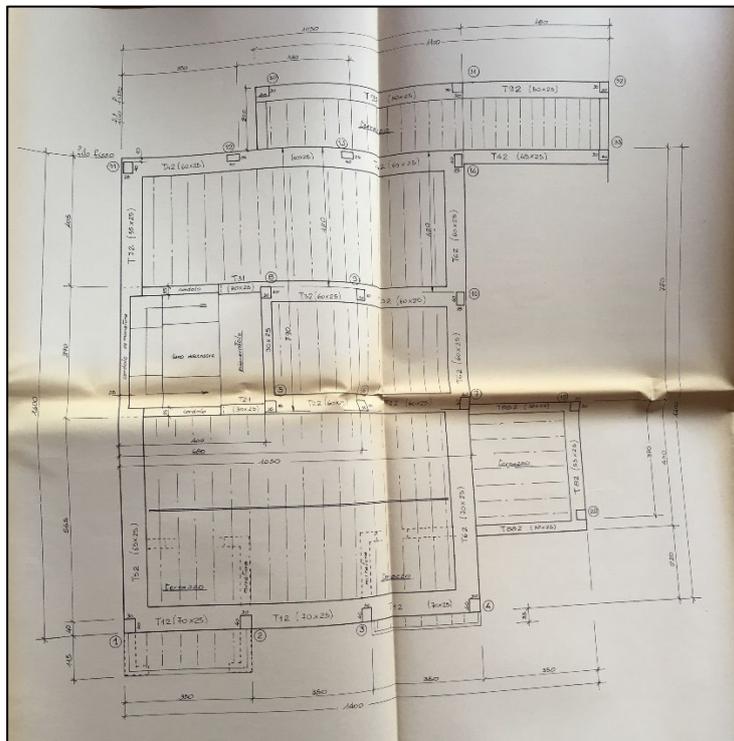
Pianta del terzo orizzontamento dei solai
